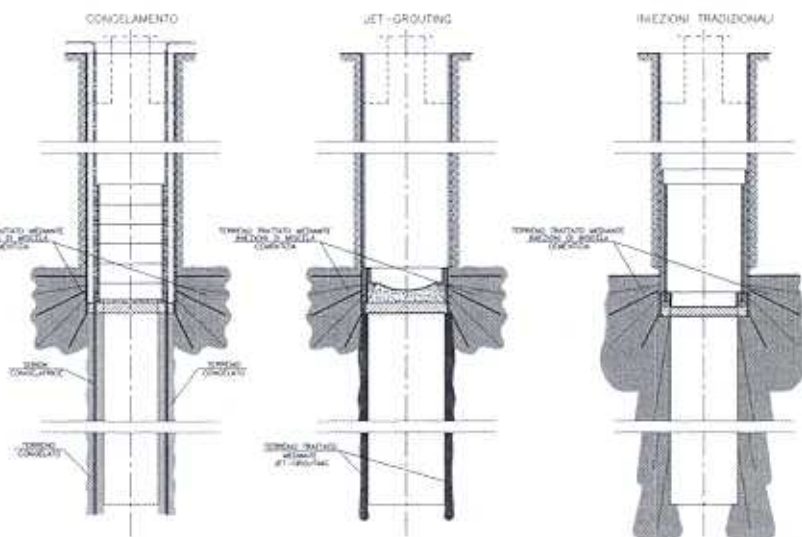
Soluzioni alternative studiate per la fondazione della pila 2 (sezione)
